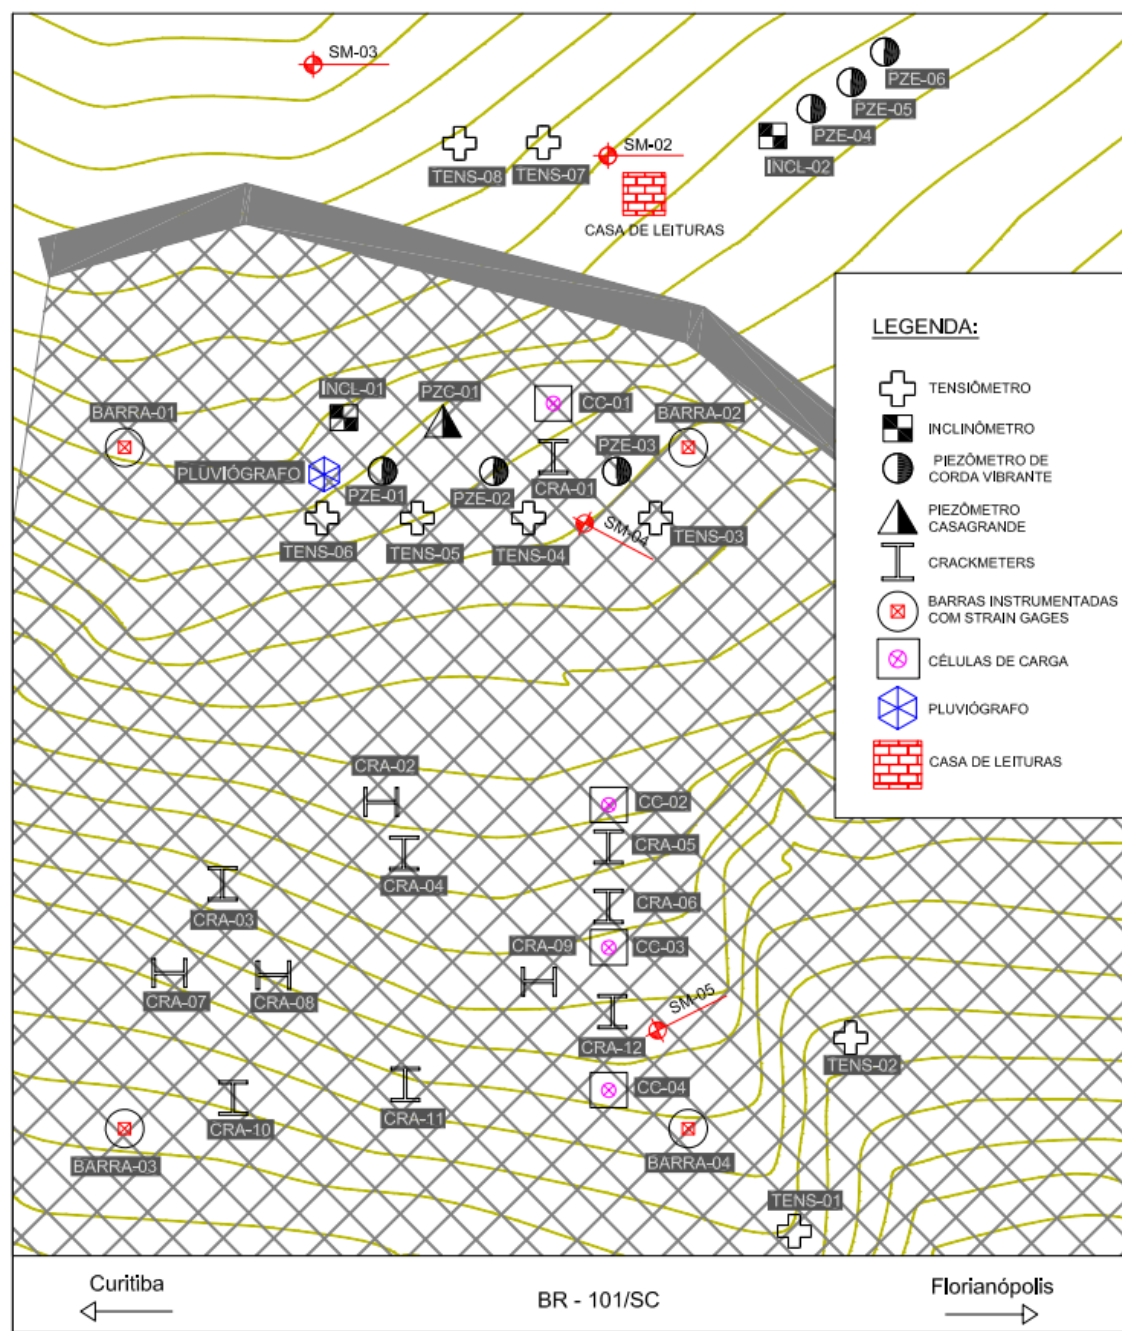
Croqui de instalação dos instrumentos em planta Fonte: Sestrem (2012)
